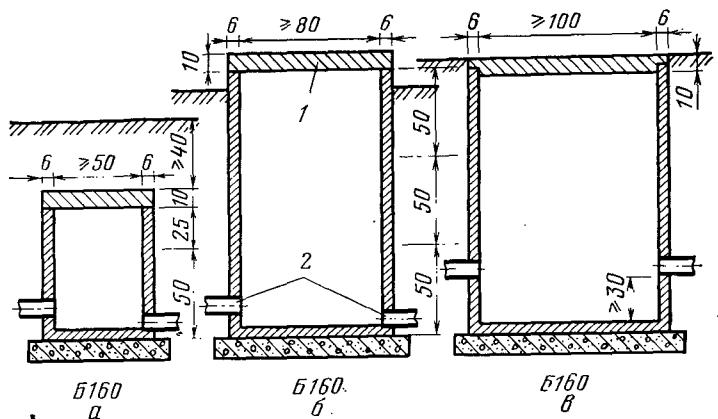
Различные дренажные колодцы из бетонных труб [7.23]:
